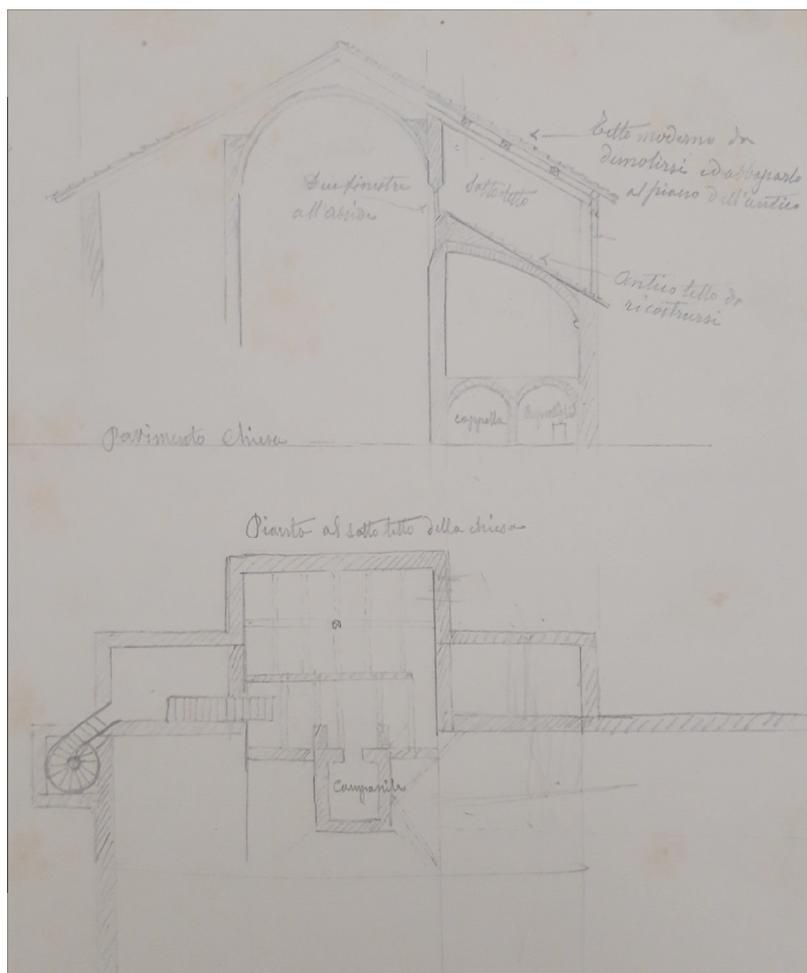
Giovanni Seglie, schizzi della planimetria e sezione trasversale dei sottotetti (in Archivio Storico SABAP-TO, fascicolo 158,1899)
